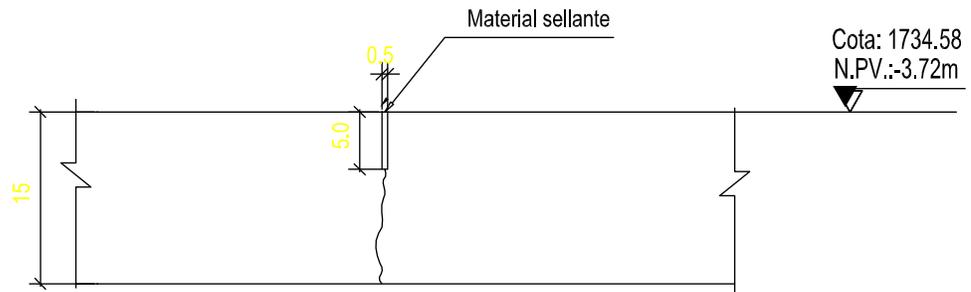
Sección típica pavimento. (Fuente: departamento de diseño Metálicas e ingeniería S.A.)
